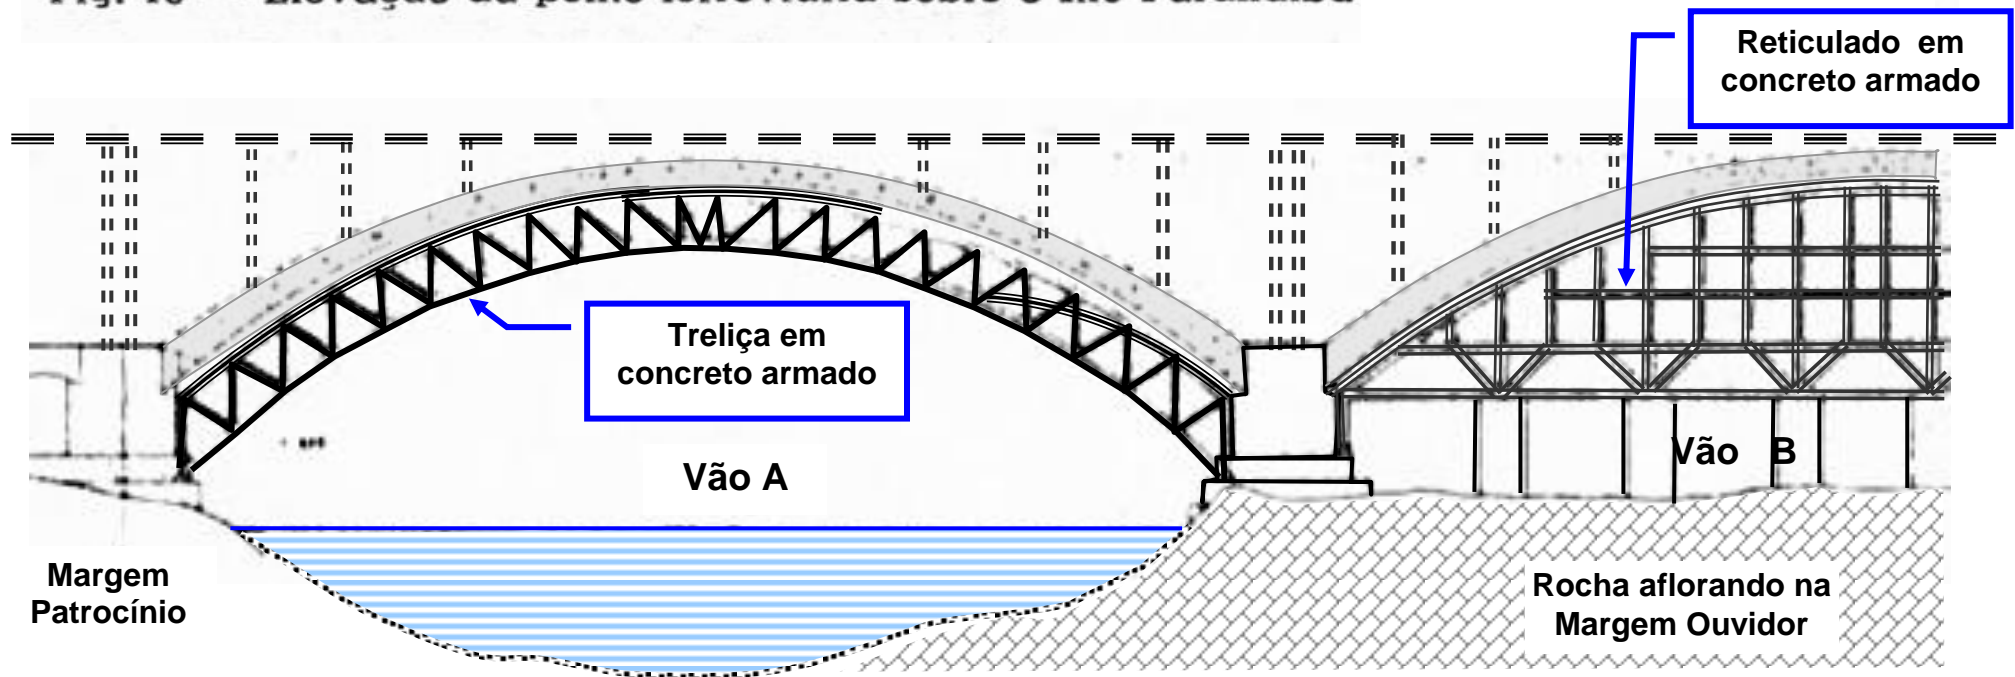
Os escoramentos de concreto armado dos arcos estruturais da Ponte Paranaíba.
